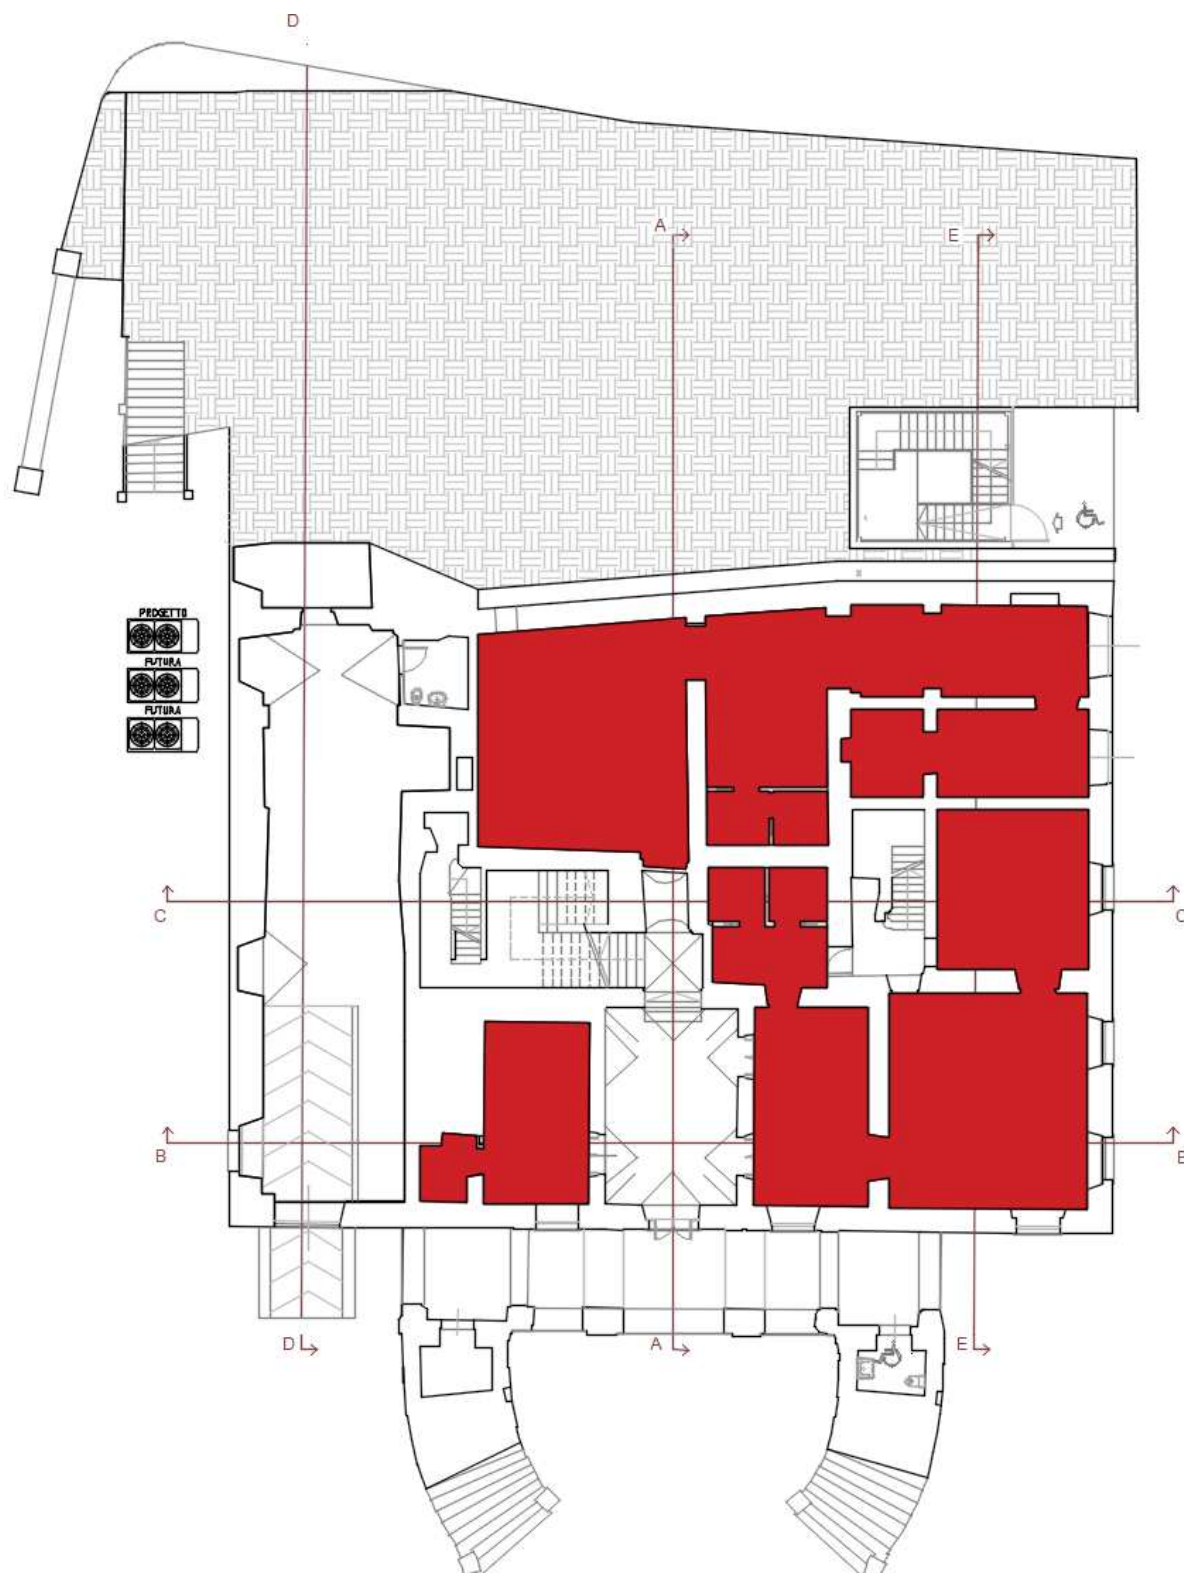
Impianto pannelli radianti a pavimento Piano Terra
